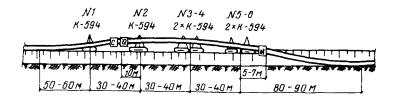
Размещение механизмов в колонне при укладке трубопровода № 1420 мм в условиях устойчивых грунтов
